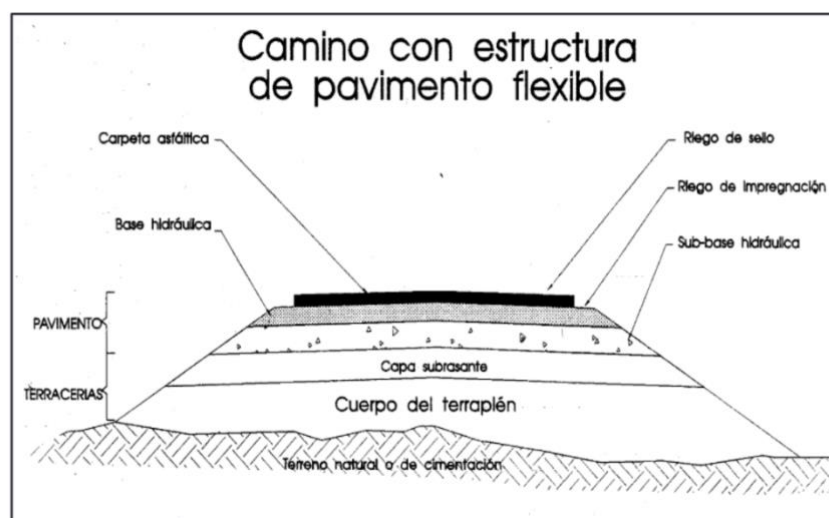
Esquema del sistema estructural de un pavimento flexible
